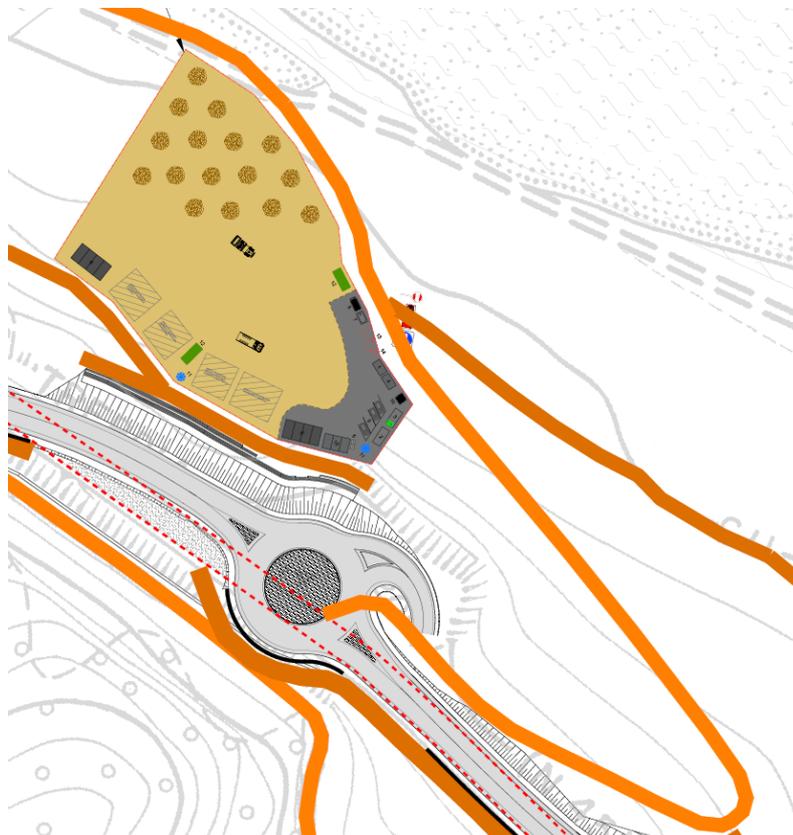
AREA CANTIERE DI SERVIZIO SC3
